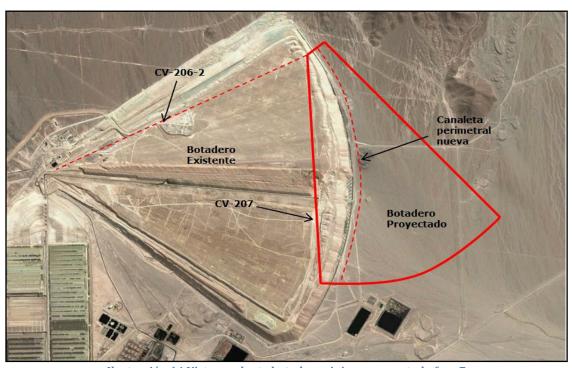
Vista en planta botadero ripios y proyectado fase 7
